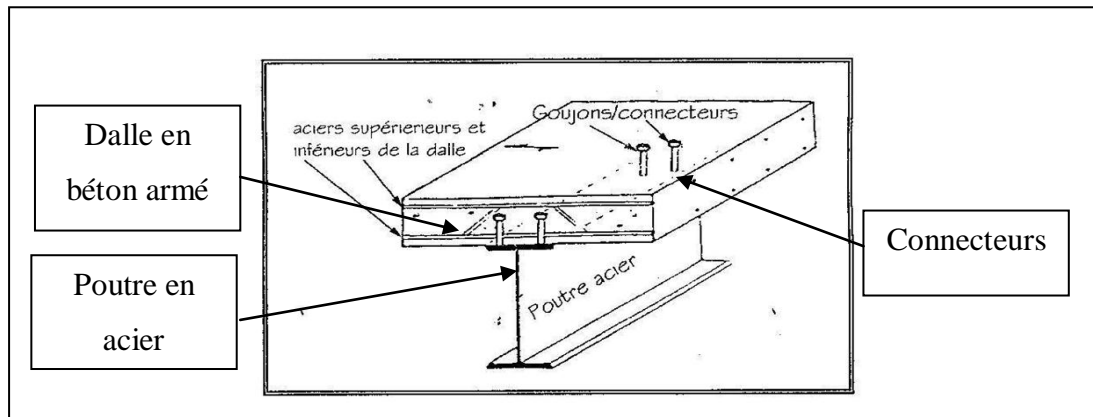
Plancher mixte collaborant avec dalles en B.A coulées sur place.⁴²
